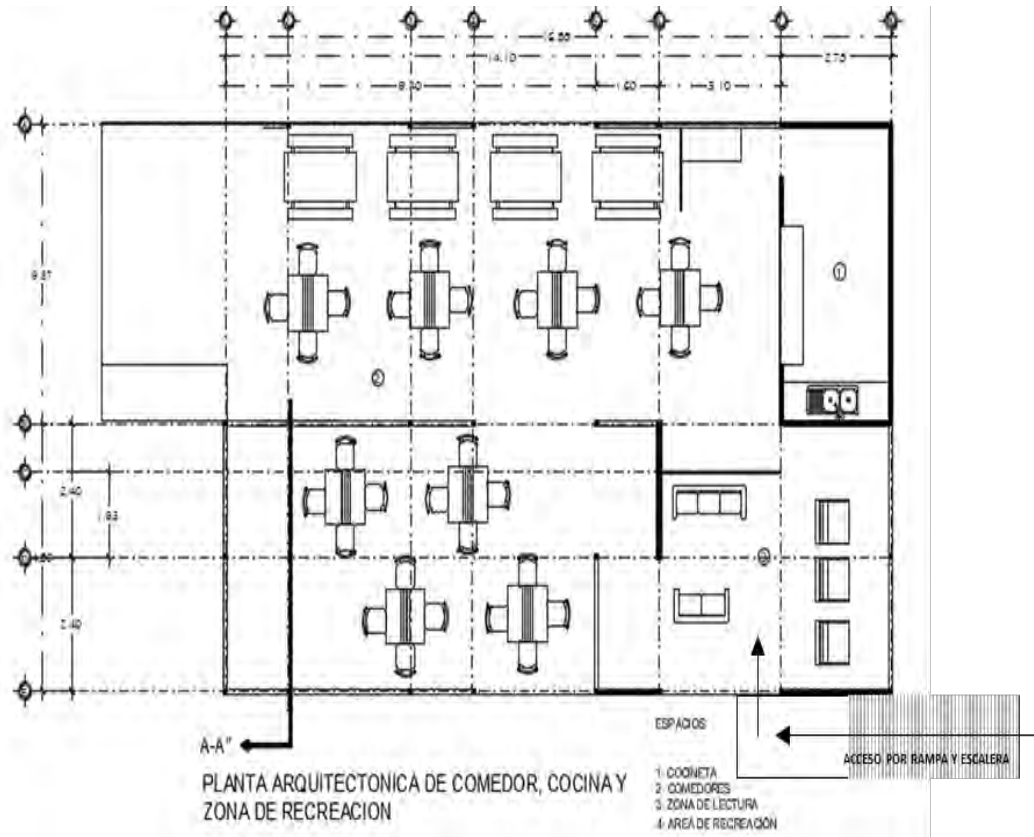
Planta arquitectónica del comedor, cocina y zona de recreación.
